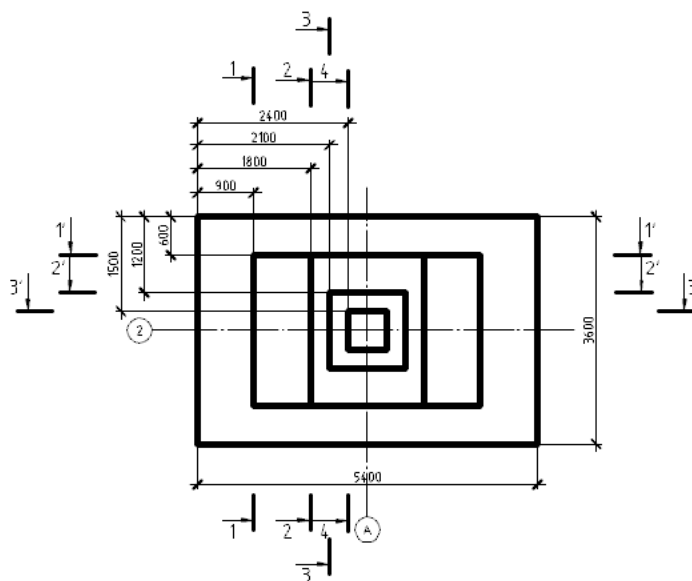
Схема к расчету арматуры плитной части фундамента
